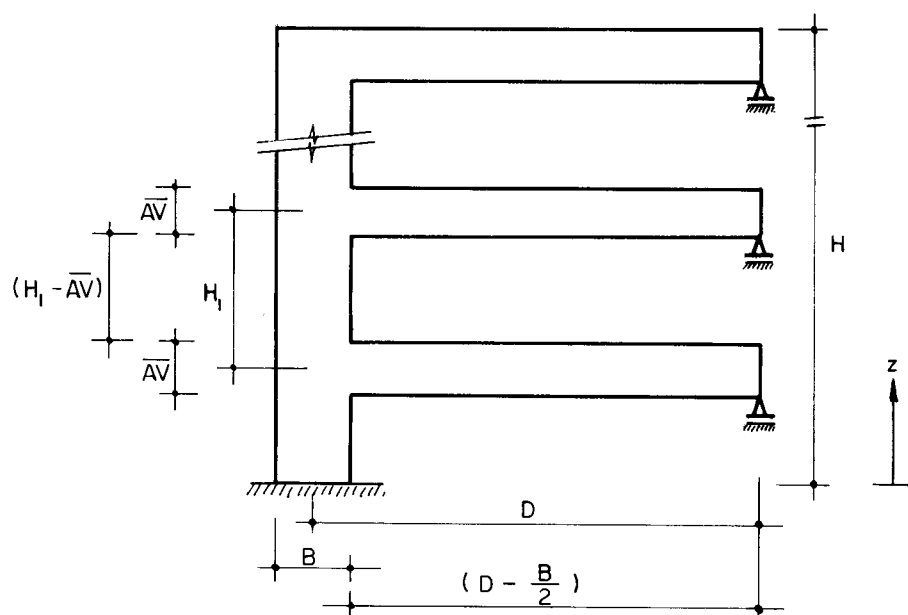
Painel com um pilar e vigas simplesmente apoiadas na outra extremidade.
